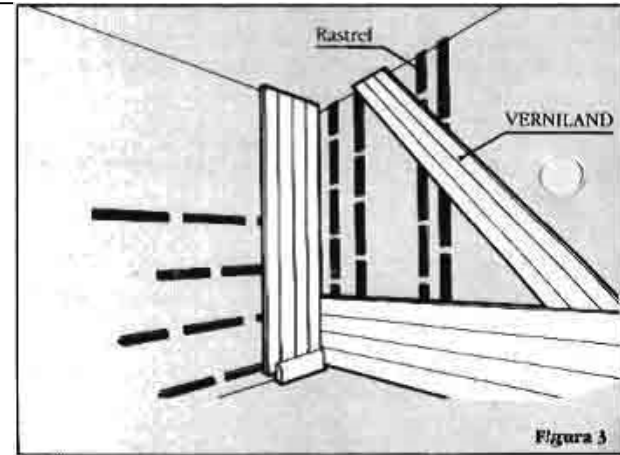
Paneles de madera tomado de: http://www.construmatica.com/construpedia/Paneles_para_Paramontos
